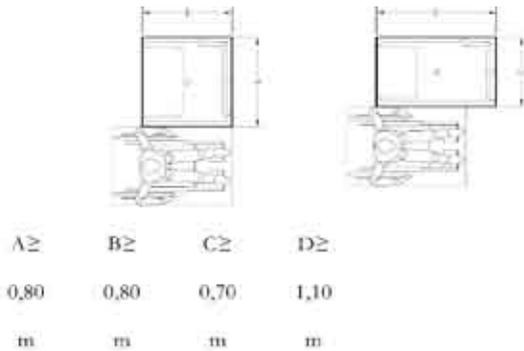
Dimensões da base de duche acessível sem entrada de cadeira de rodas.
